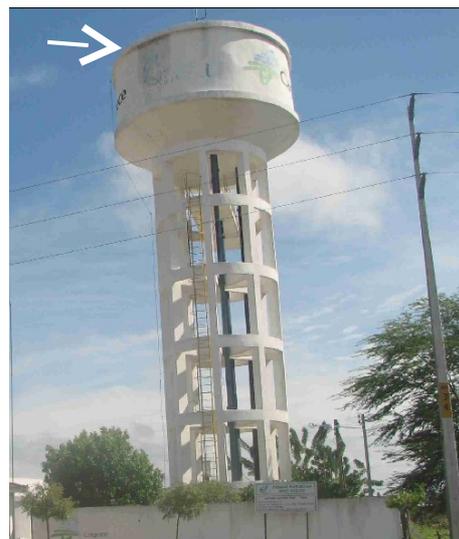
REL-01: ausência de guarda-corpo na laje de cobertura.
